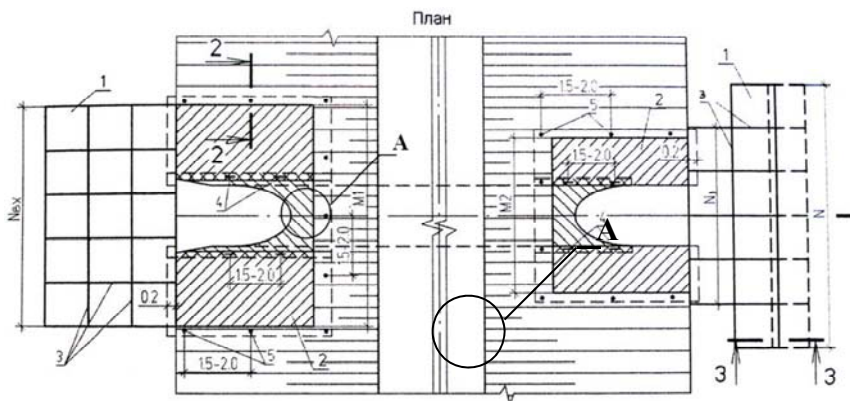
Схема плана трубы при укреплении откосов нетканым геотекстильным полотном русла плитами ПК 100.12.е: 1 – плиты ПК100.12.е; 2 – НГ СТ; 3 – строительный раствор; 4 – скобы; 5 – кольца
